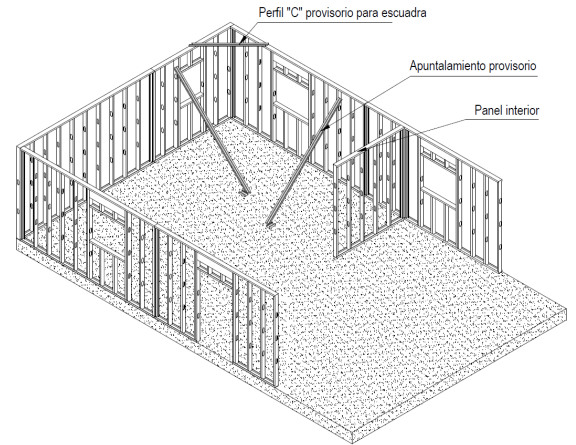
Montaje de los paneles estructurales sobre solera.
